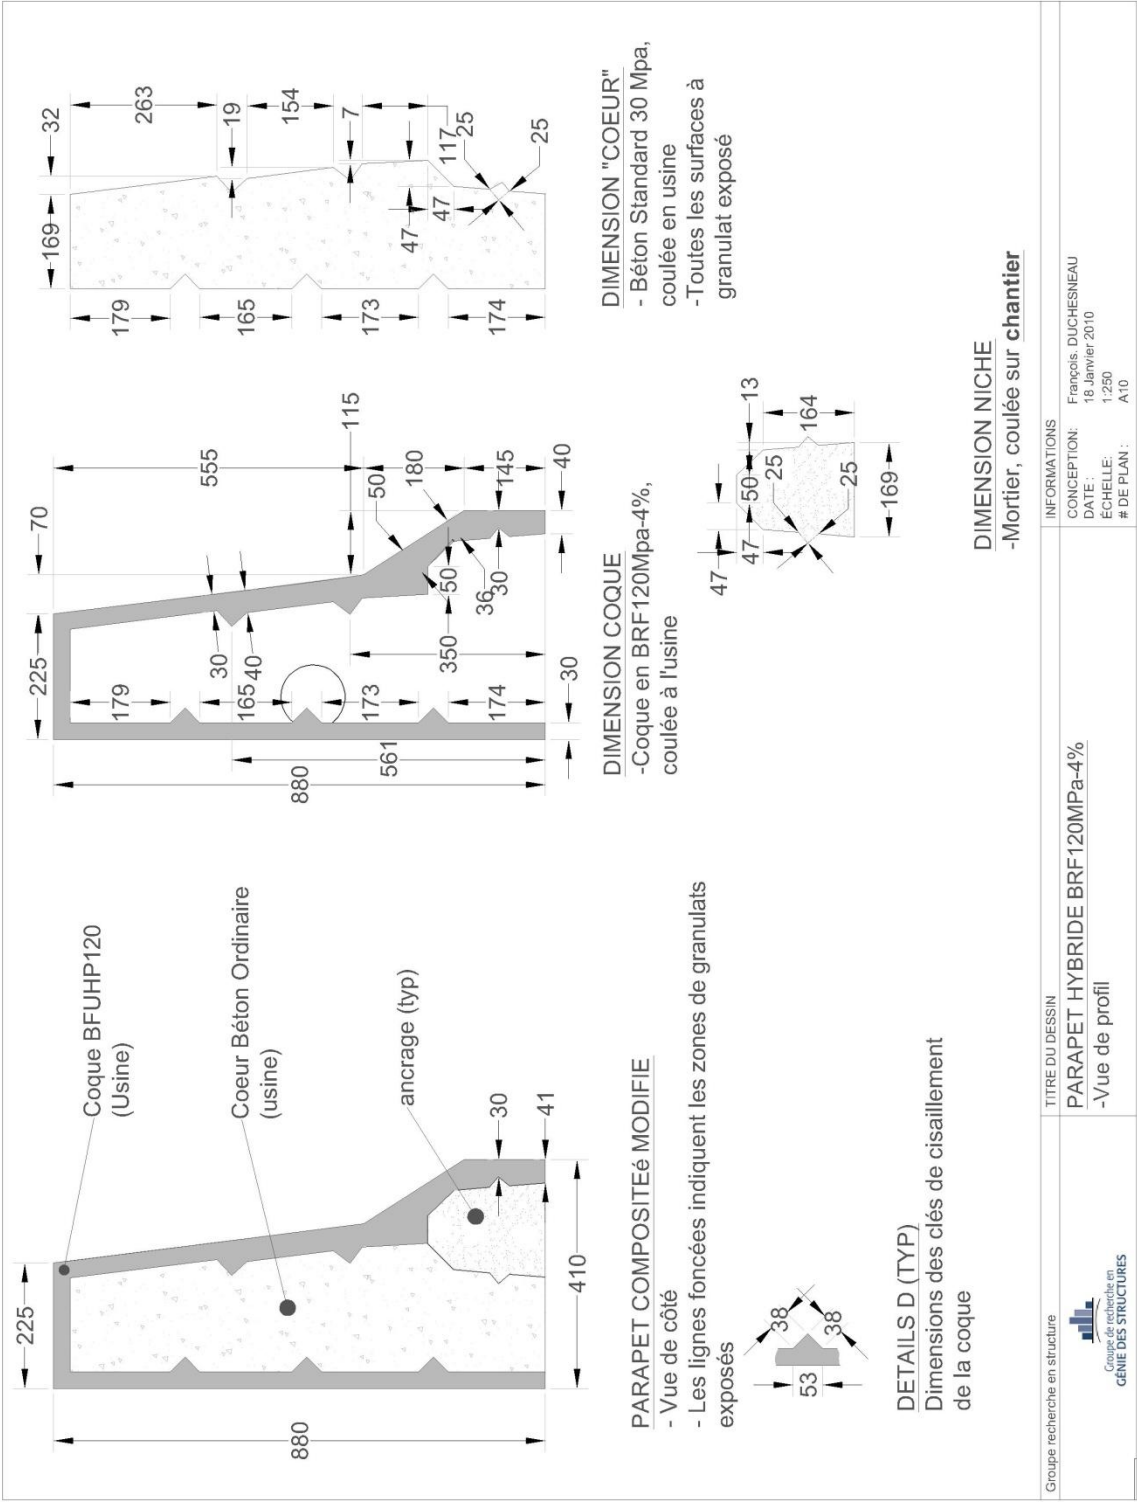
Plan de profil du parapet hybride BRF120MPa-1.5%/BO35Mpa
